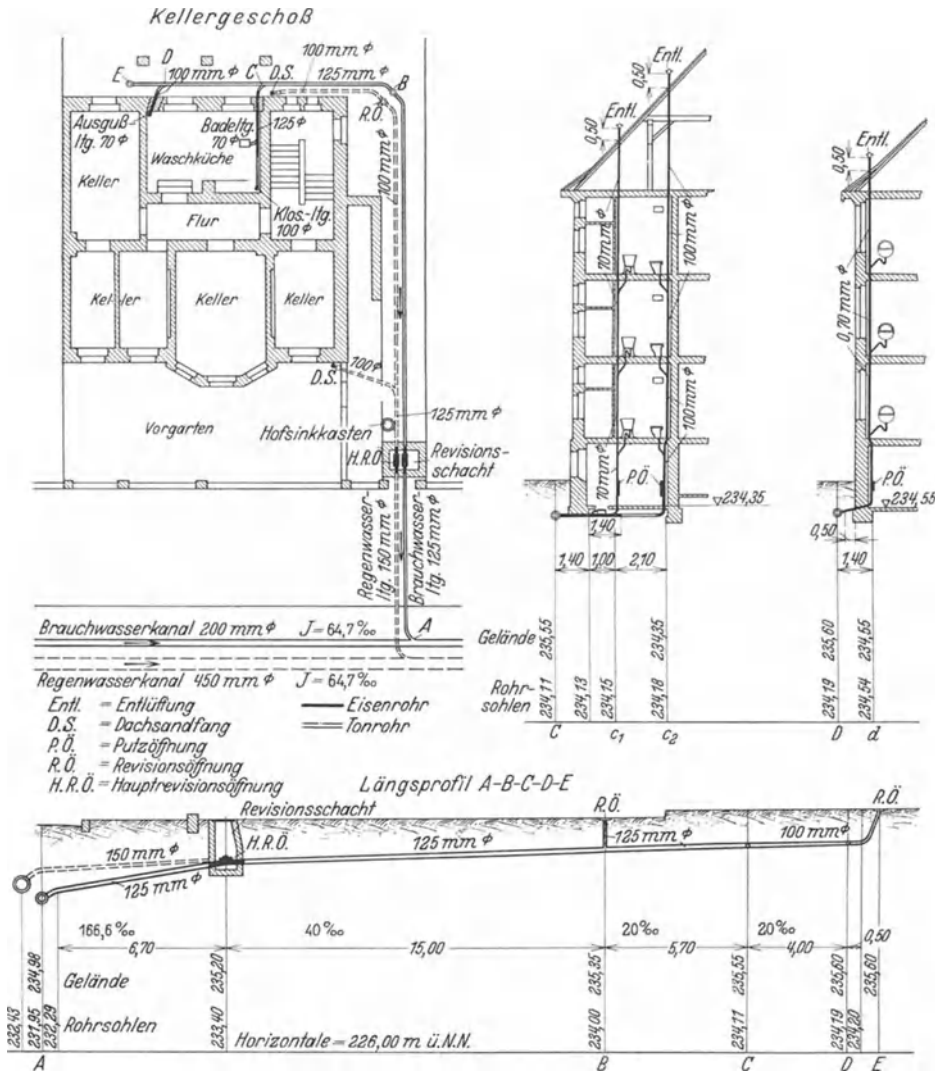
Grundstücksentwässerung im Trennverfahren.
